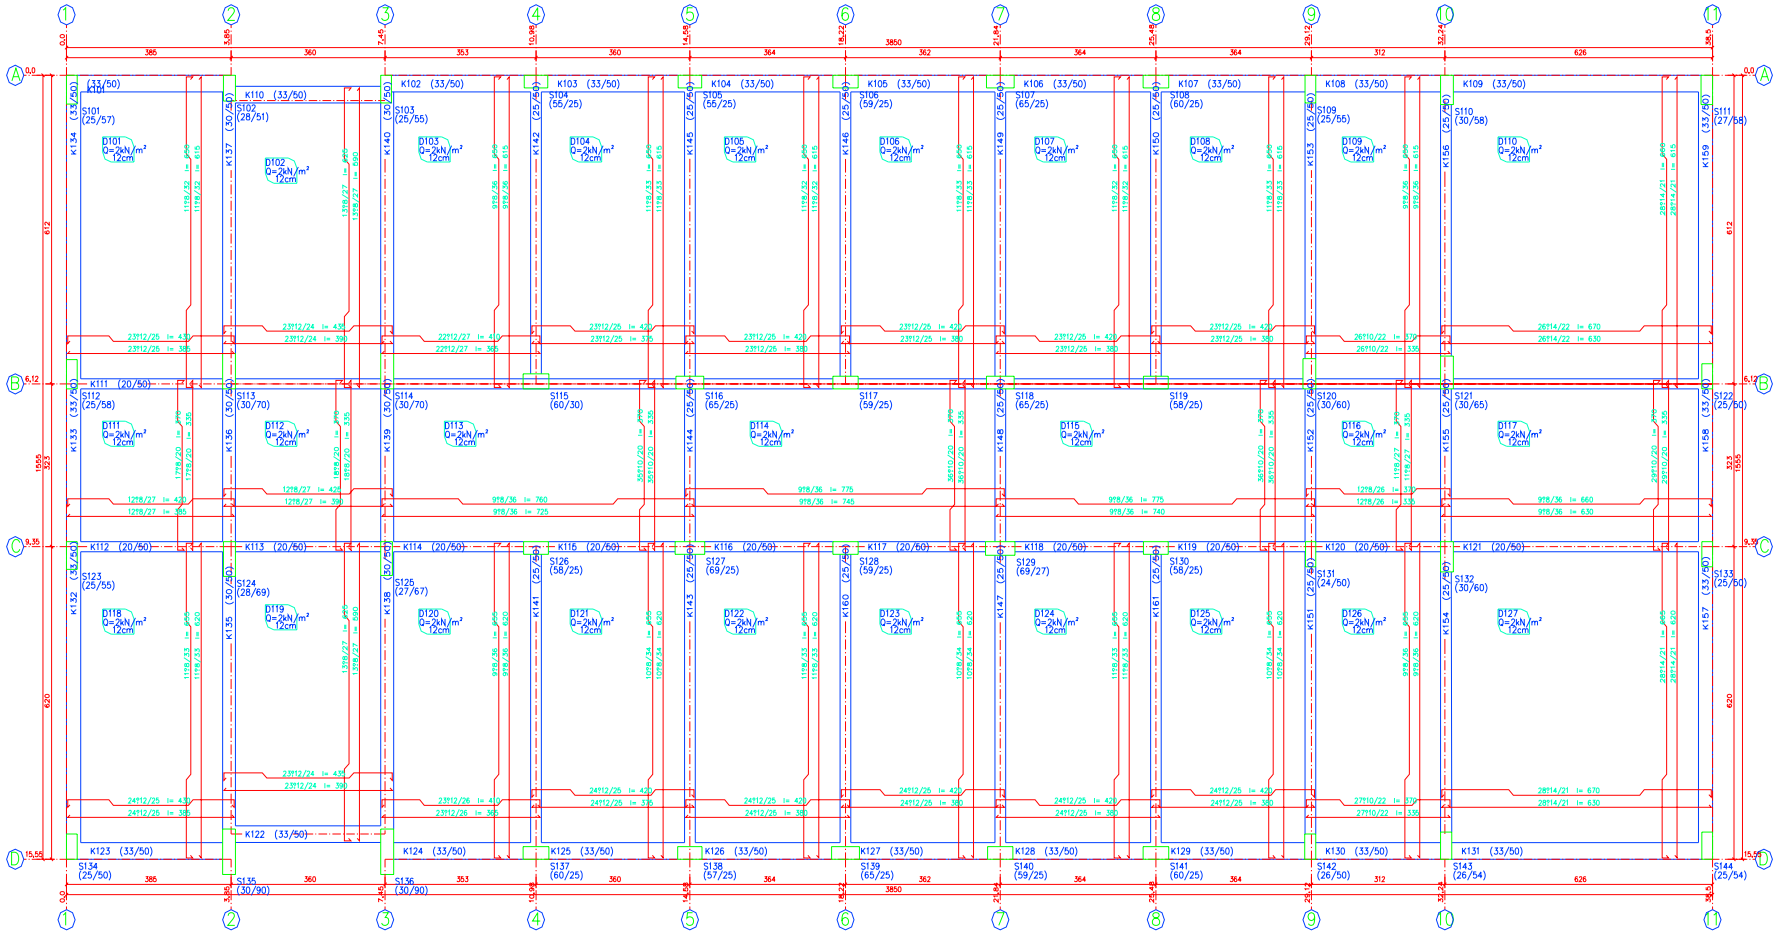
Şükriye Onsun Okul Binası temel aplikasyon planı
